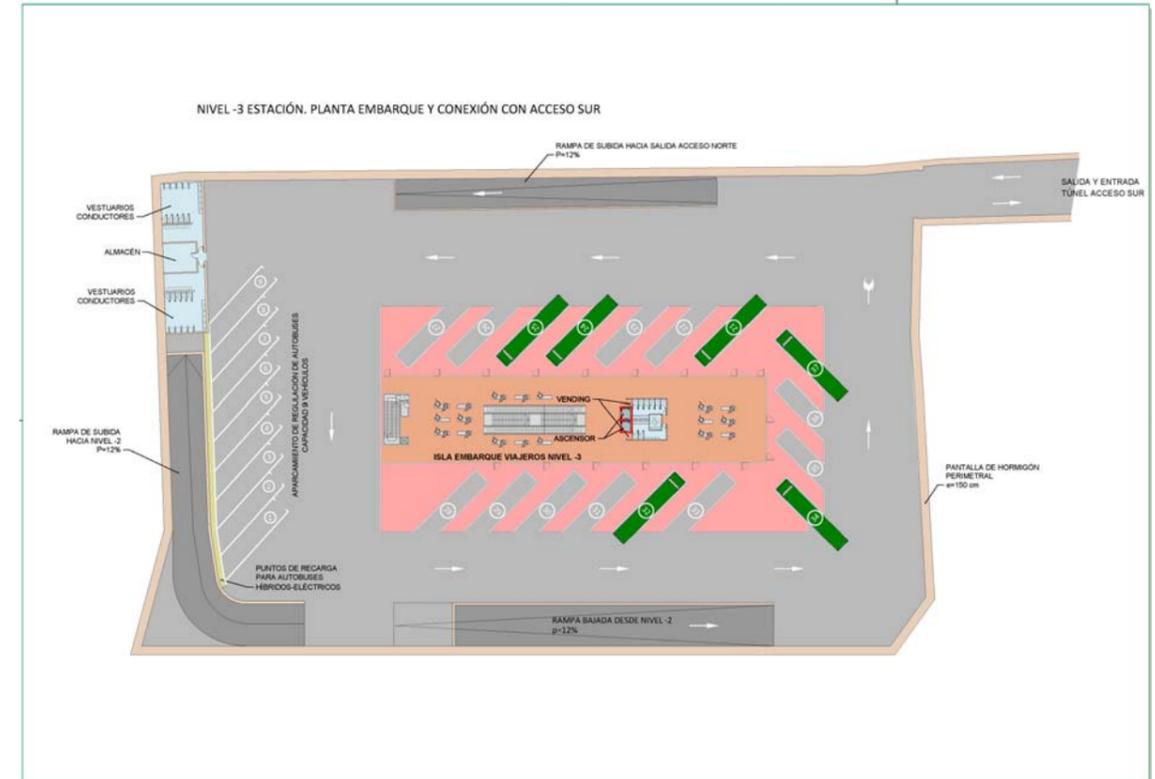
Alternativa-1. Planta -3 (Planta -2 de operativa de autobuses).
